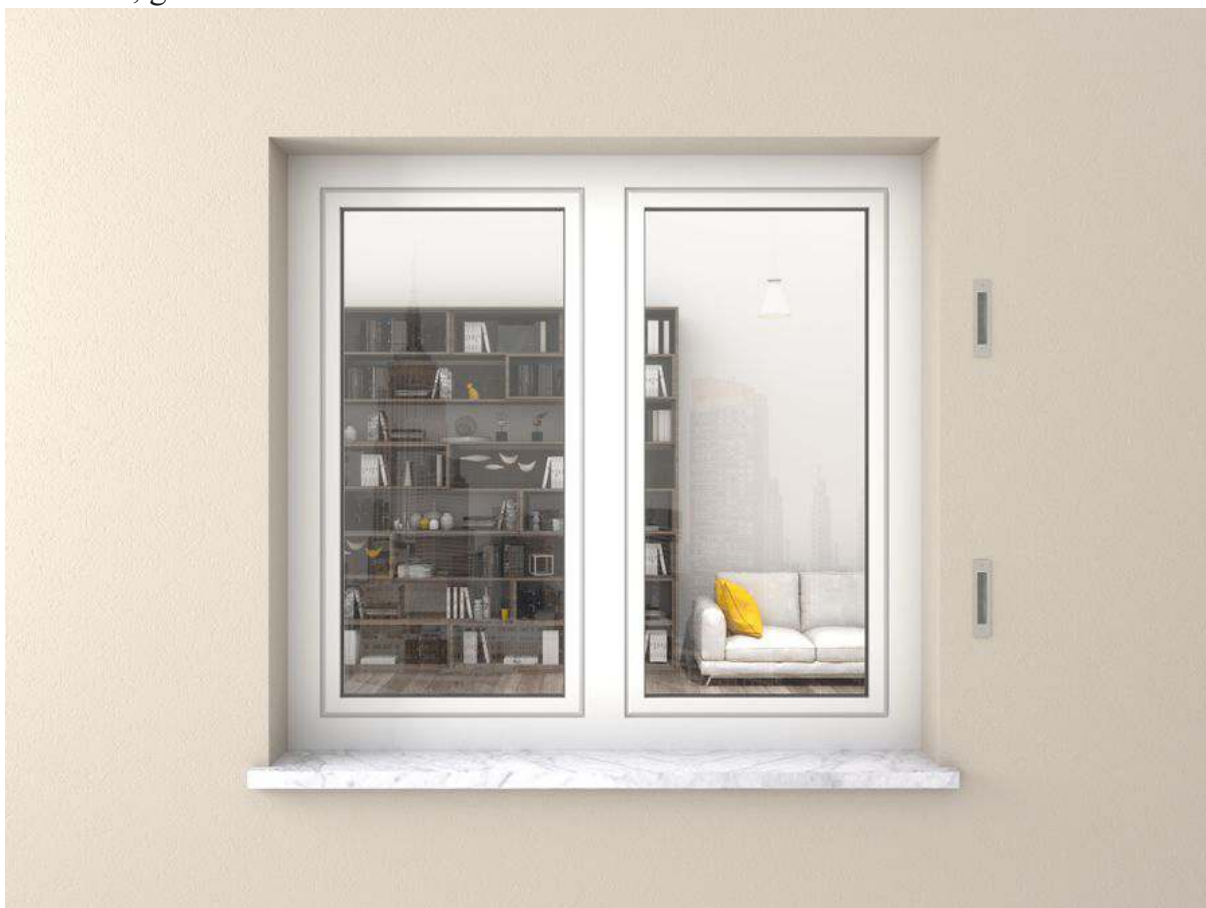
Vista dall'esterno VMC incassata a muro (Fonte: www.thesan.com)
